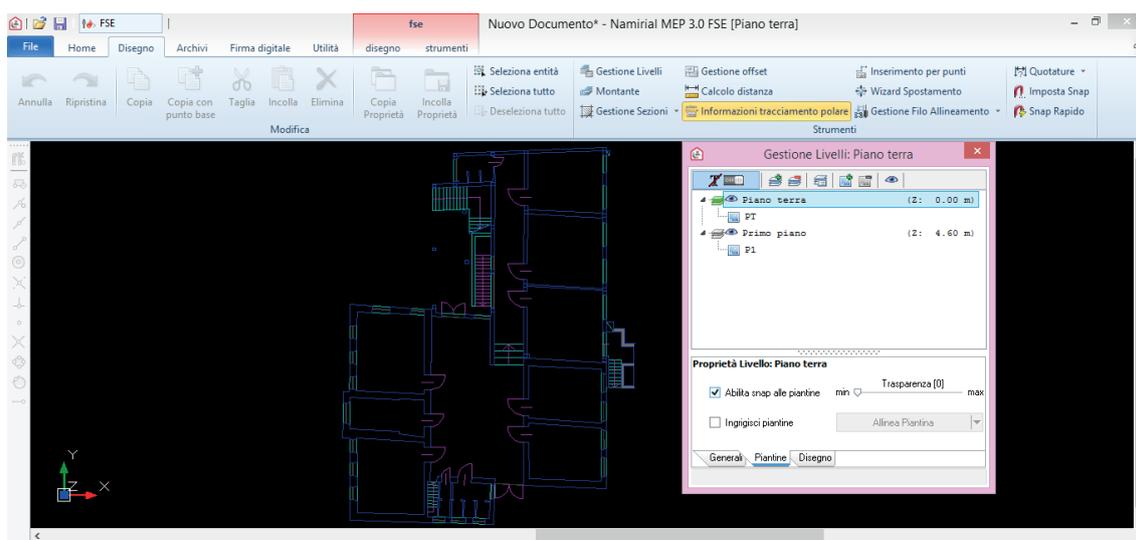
Importazione delle planimetrie e suddivisione dei piani in livelli
